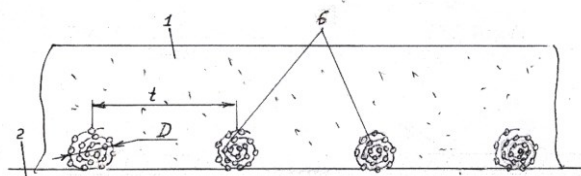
Насыпь с установленными вентиляционными бухтами: 1 – насыпь; 2 – основание; 6 – бухты
